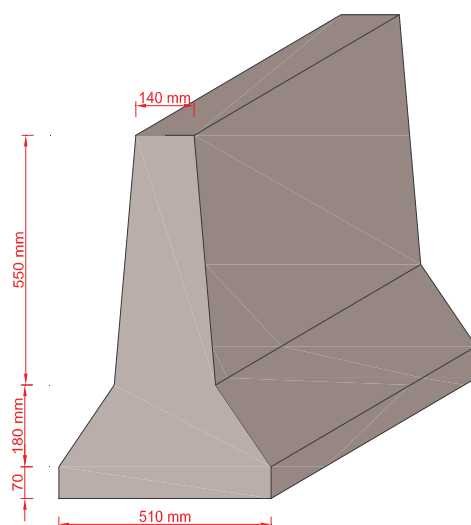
Execução de barreira de betão tipo New Jersey “*in situ*”
